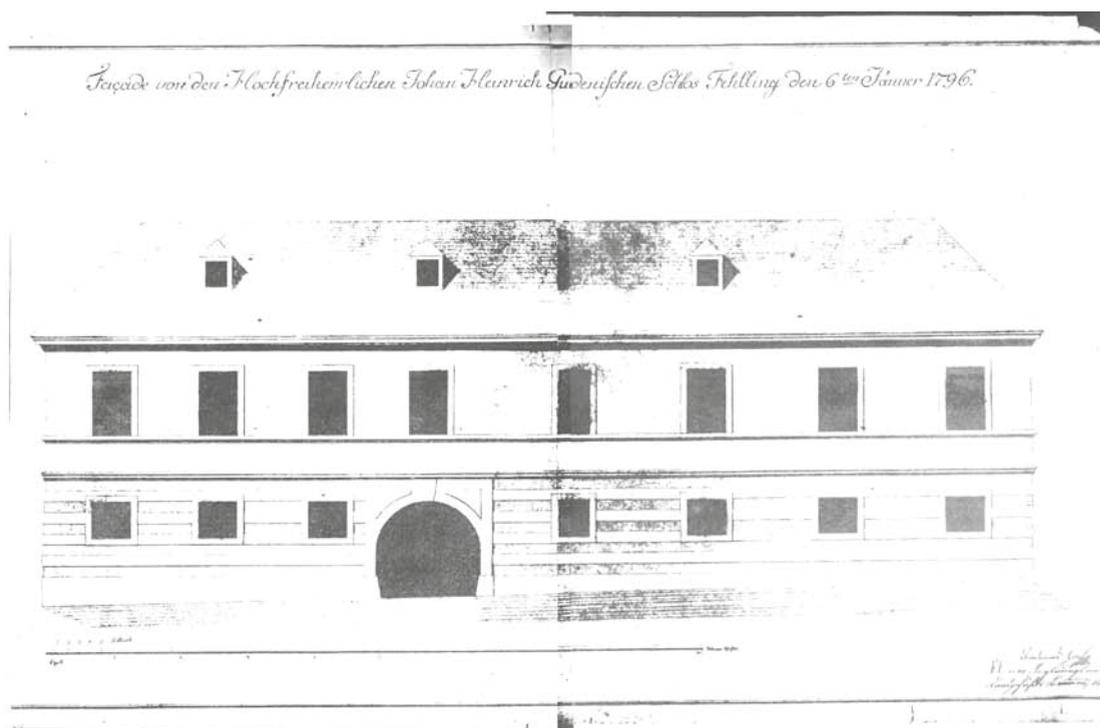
Fassadenentwurf Schloss Felling, Andreas Zach, 1796
